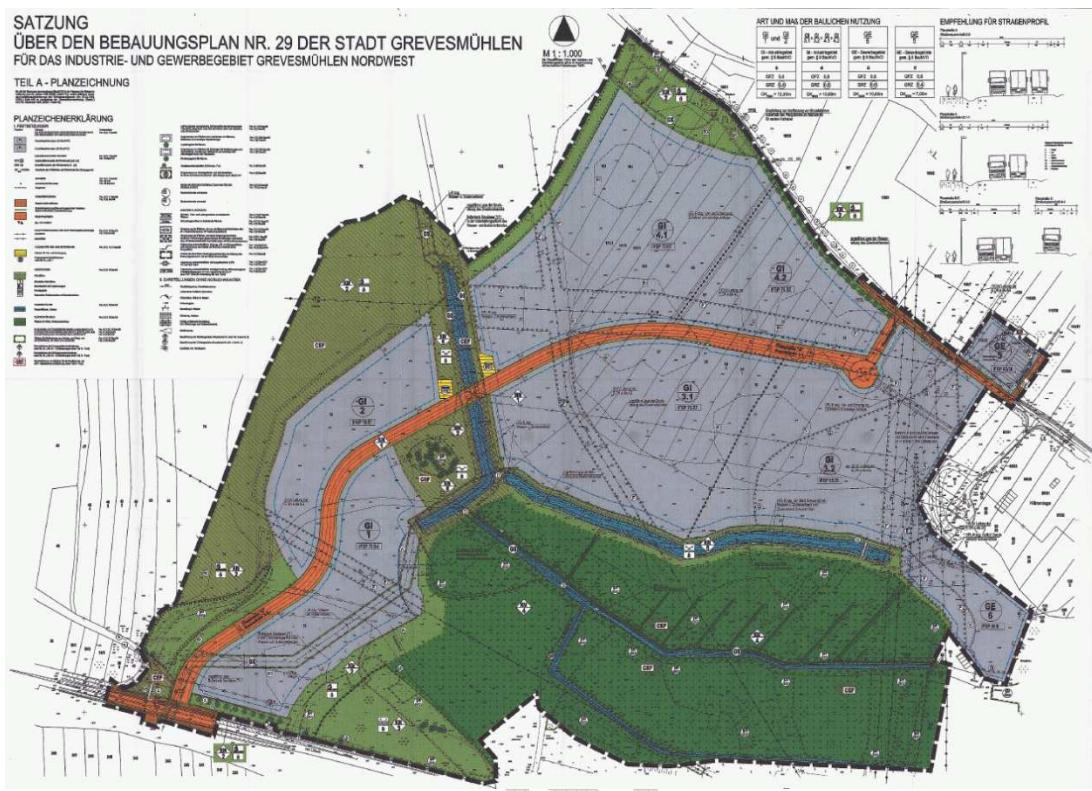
Derzeitiger B-Plan (© Planungsbüro Mahnel)
